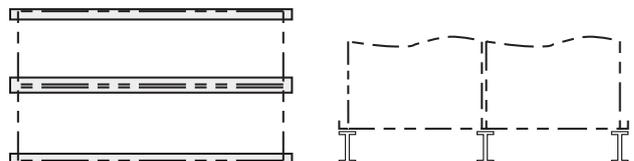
Stahlunterkonstruktion (17', 20' and 24' [5,2 m, 6,0 m und 7,3 m] breite Modelle)
